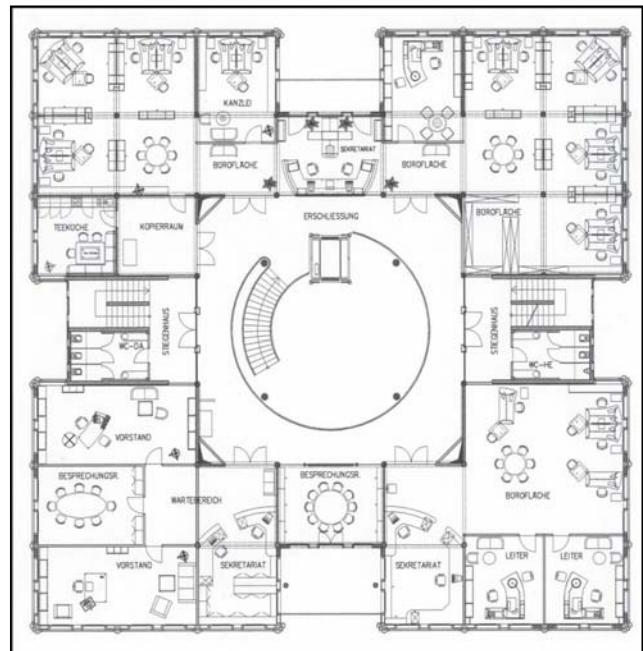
Grundriss 1. Obergeschoss
